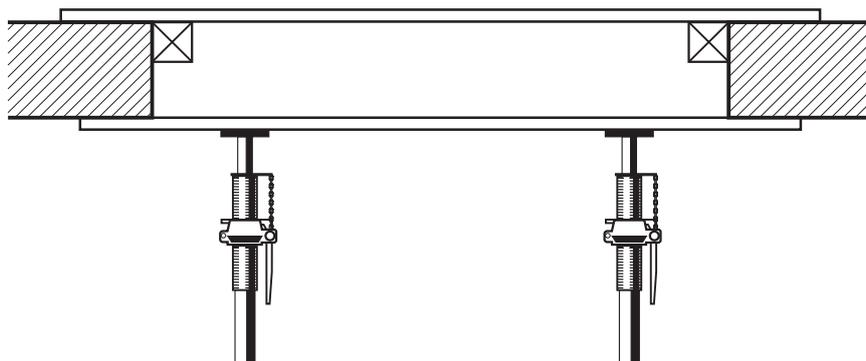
Cobertura de recortes no pavimento e no tecto
